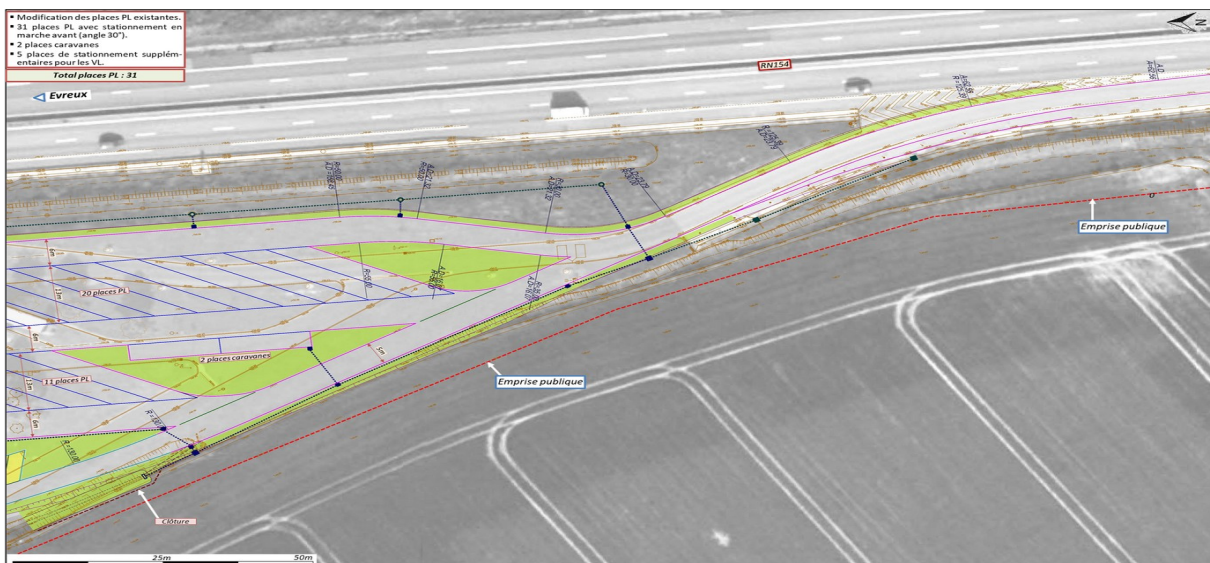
Aire de repos de la Mare des Fourches - Plan général 2/2
